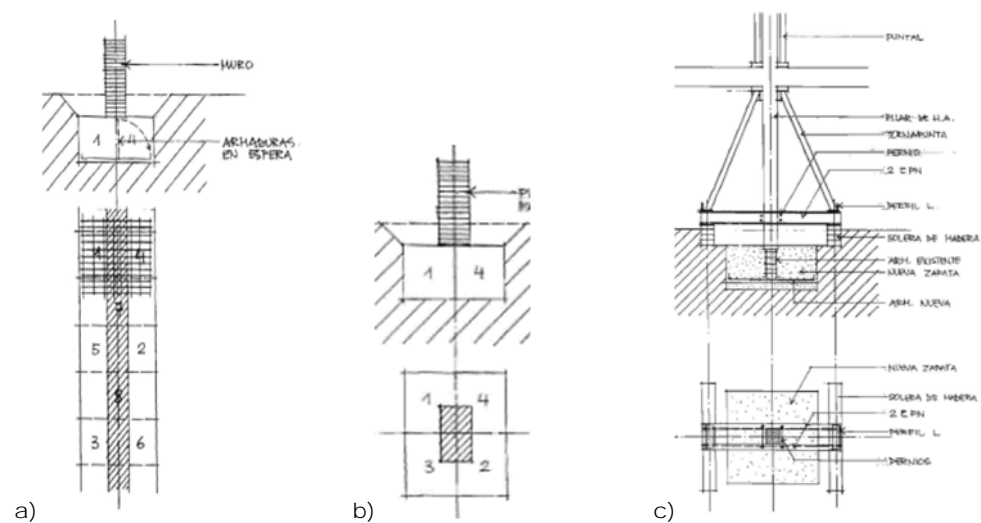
Sustitución de zapata a) corrida bajo muro; b) aislada bajo pilastra de ladrillo; c) aislada bajo pilar de hormigón armado [4]
